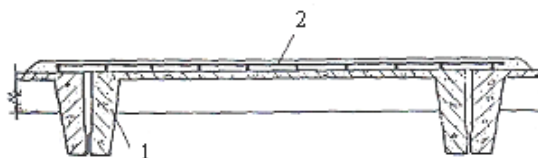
Усиление сборной плиты перекрытия наращиванием сверху:
